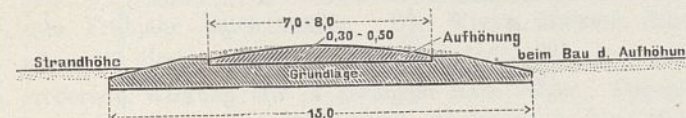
Senkstück mit Böschungen mit Aufhöhung in Packwerk.
